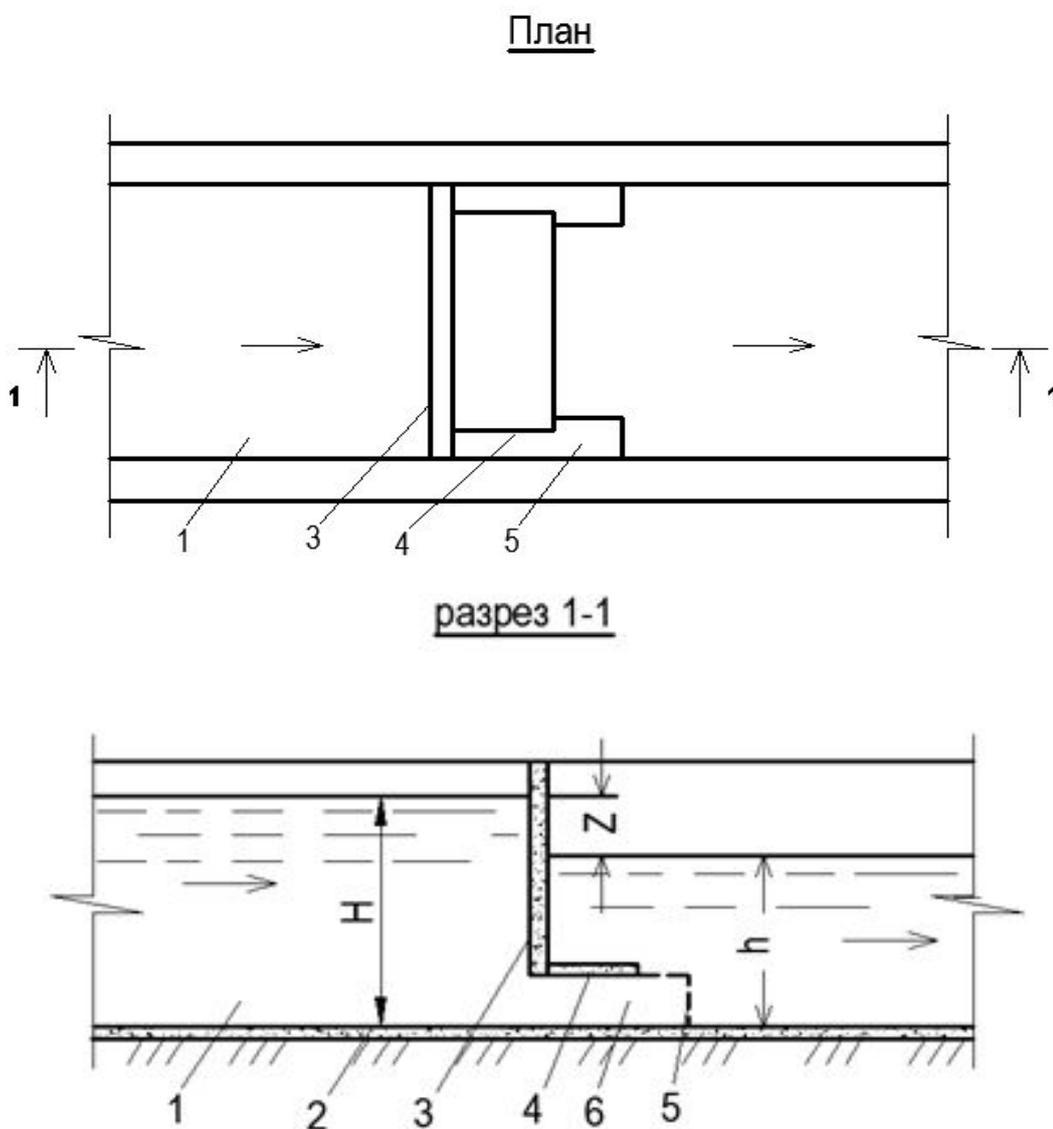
Схема водомера типа «Прямоугольный насадок» на водотоке с прямоугольным поперечным сечением
